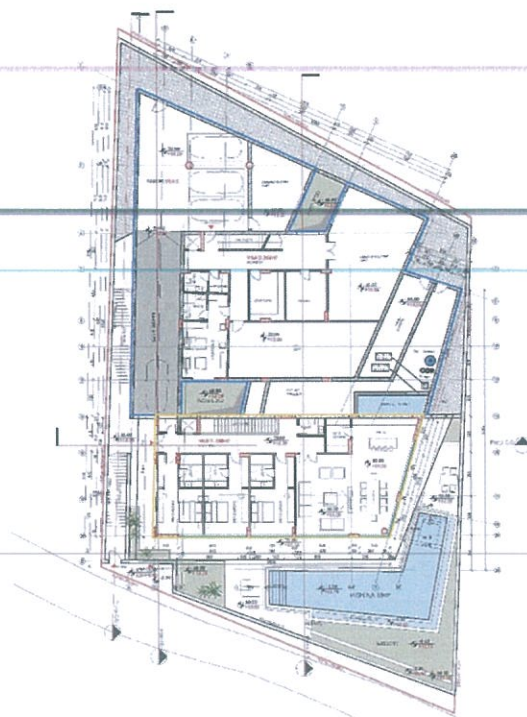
Planimetria e nëntokës Vila 2/Parkimet
